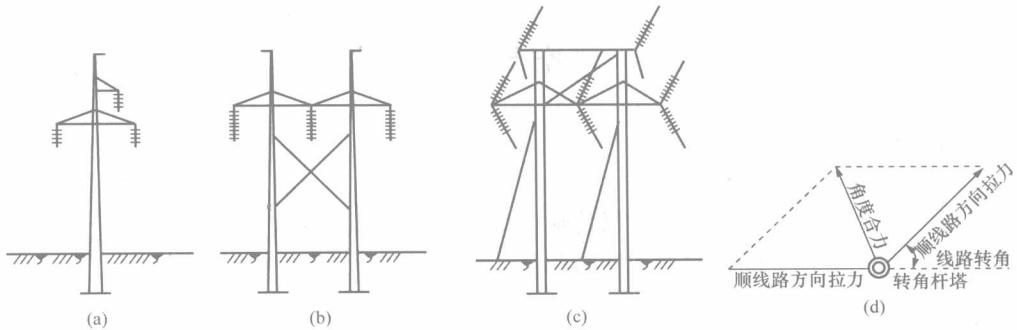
钢筋混凝土杆塔杆型及转角杆塔的受力图
